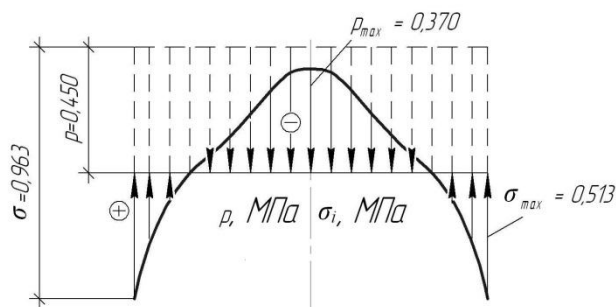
Эпюры ординат неуравновешенных контактных давлений по подошве фундамента от влияния нагрузки P и контактных реактивных напряжений грунта σ_i под подошвой фундамента
